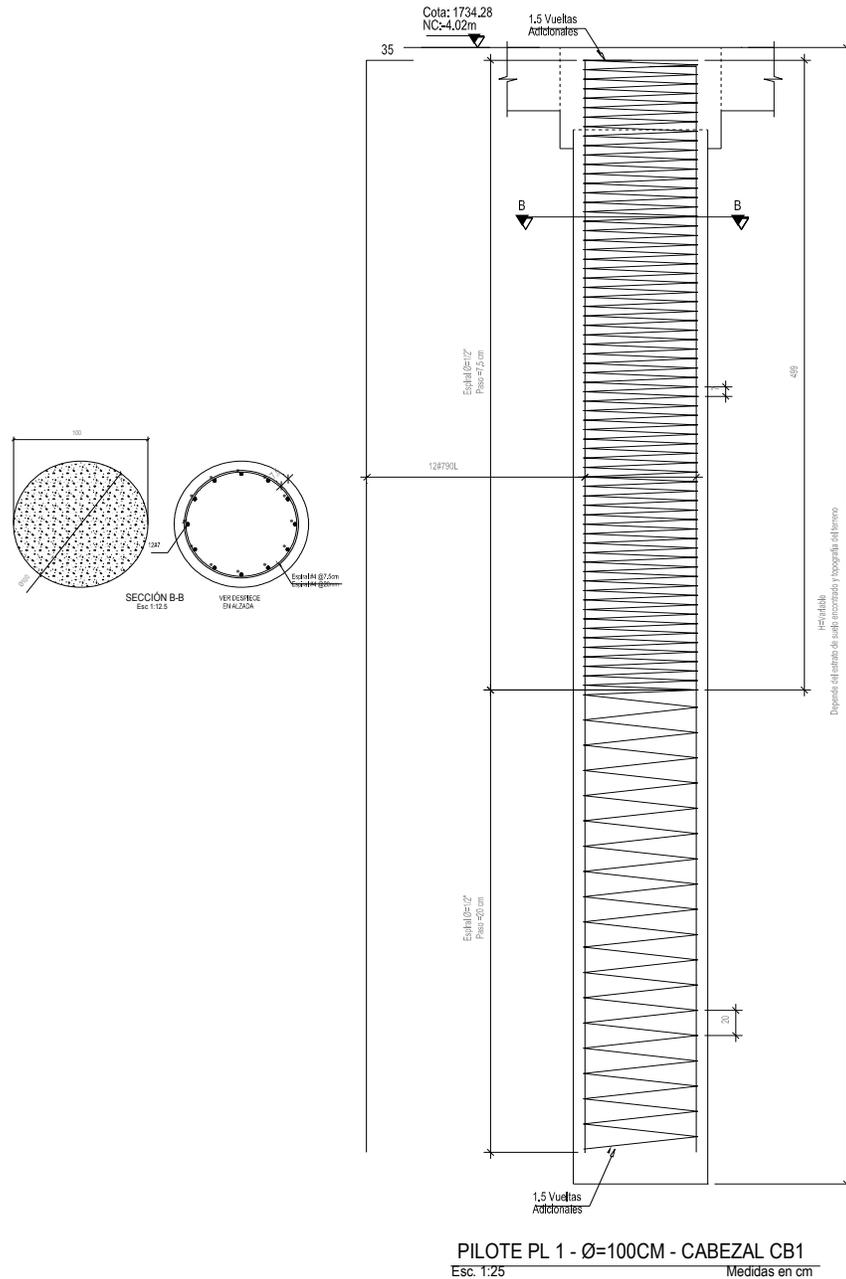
Planos de caisson (Fuente: Departamento de diseño Metálicas e Ingeniería S.A.)
